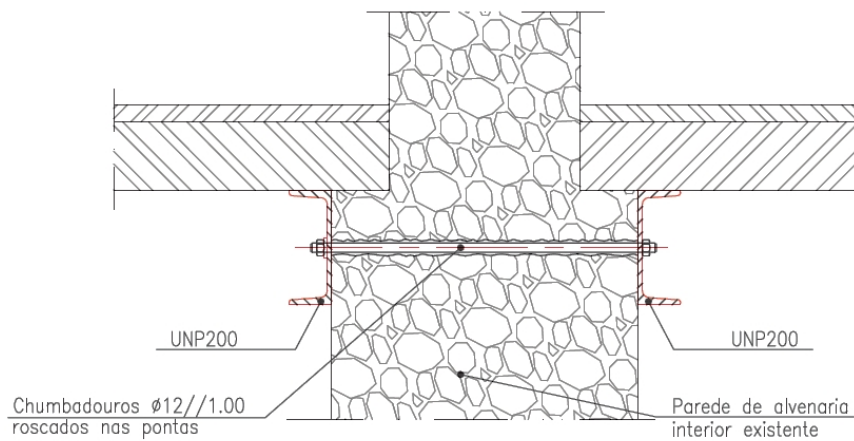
Estrutura metálica de contenção de parede interior [30]
